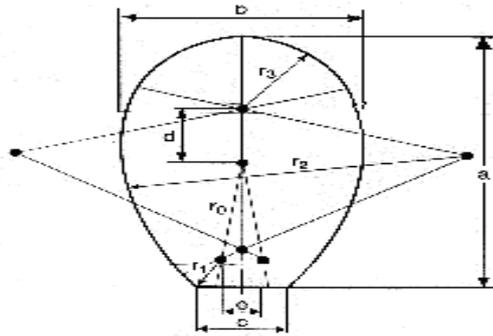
Coupe type d'un tuyau ovoïde préfabriqué [3]
